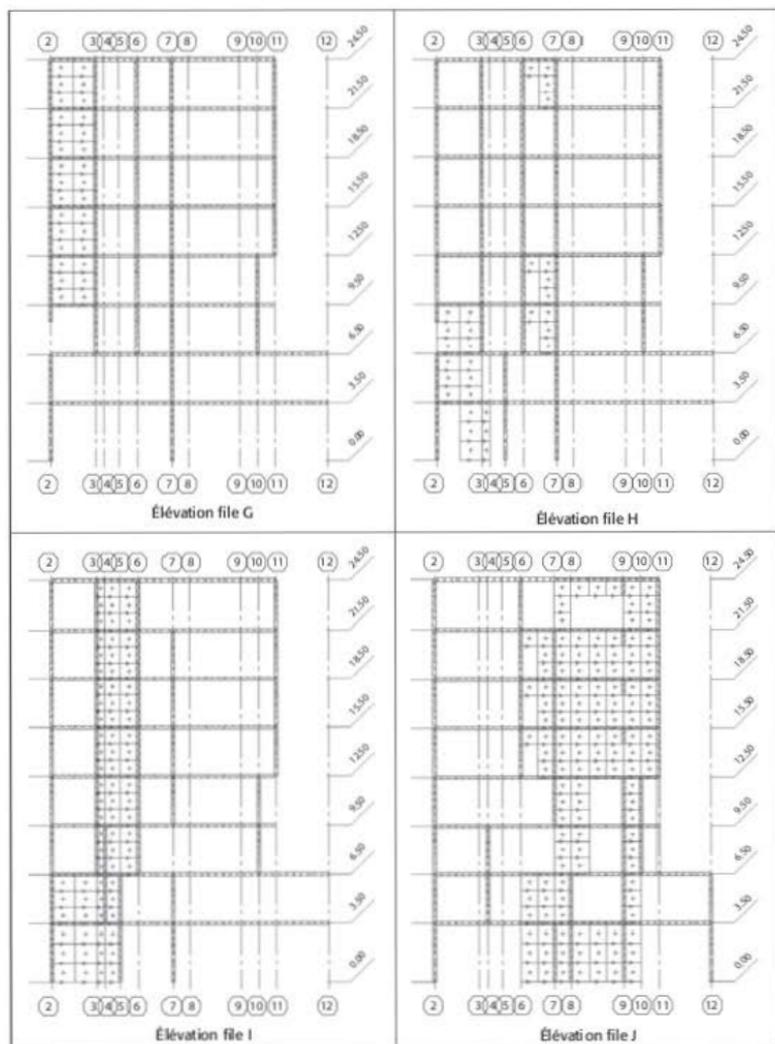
Élévation des voiles – plan XZ (3/4)
